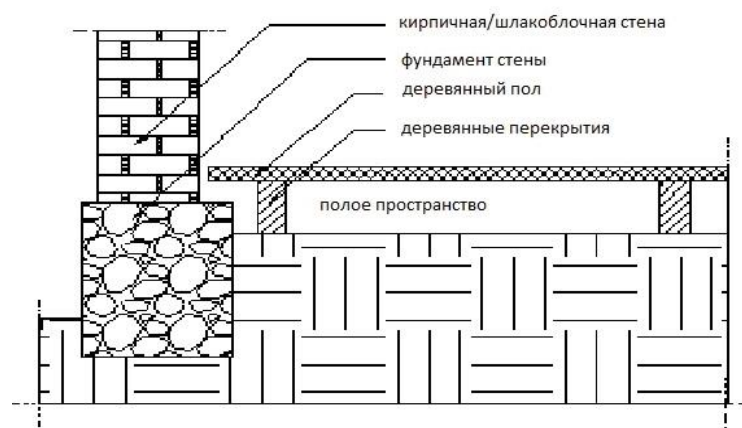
Конструкция фундамента с бетонным покрытием между грунтом и полом
